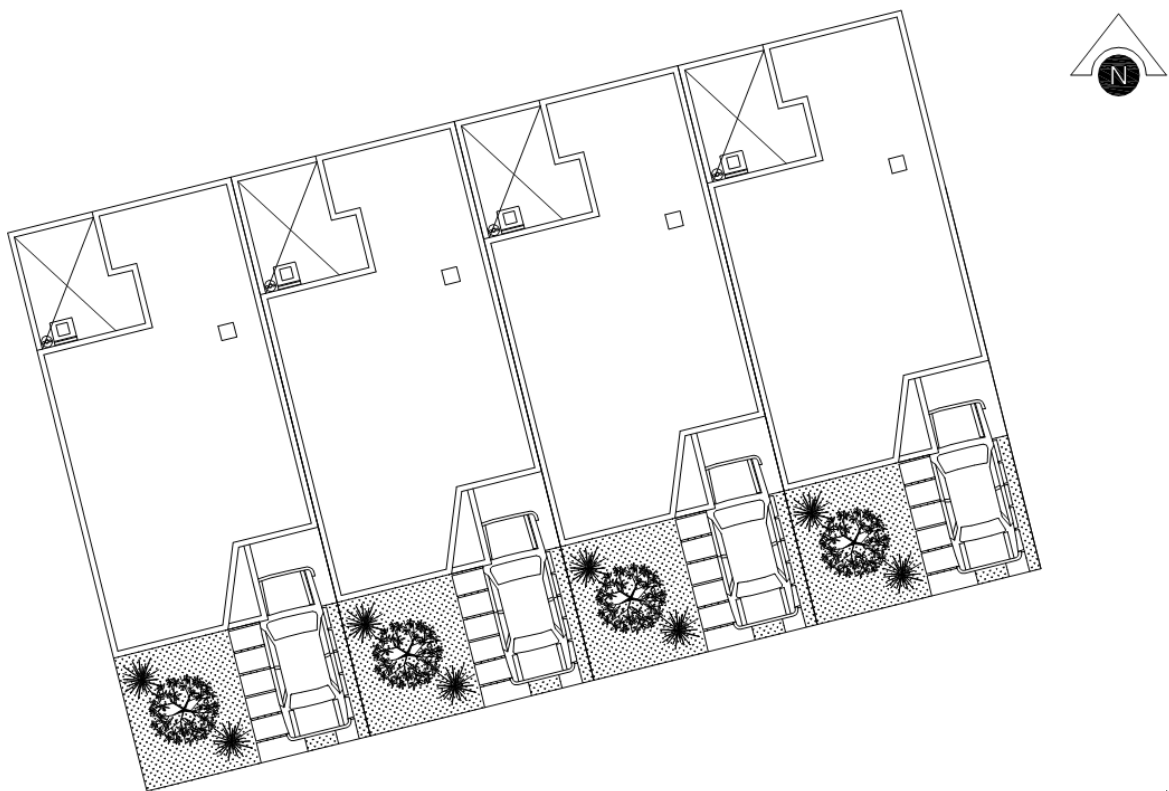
disposición en conjunto de los prototipos de vivienda, orientación sureste
